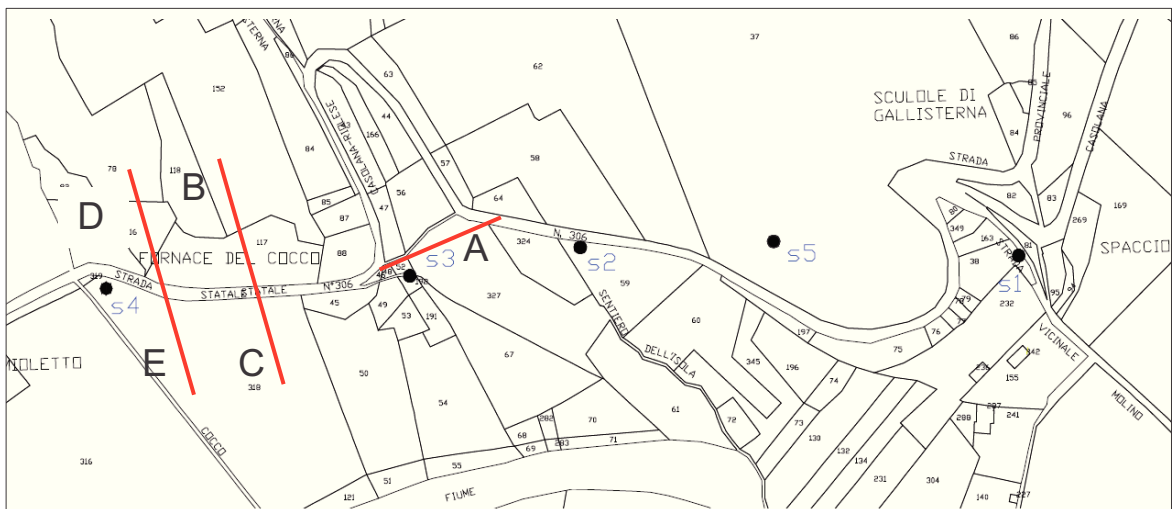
Planimetria generale della zona di intervento con ubicazione dei punti di indagine e delle sezioni sismiche.
